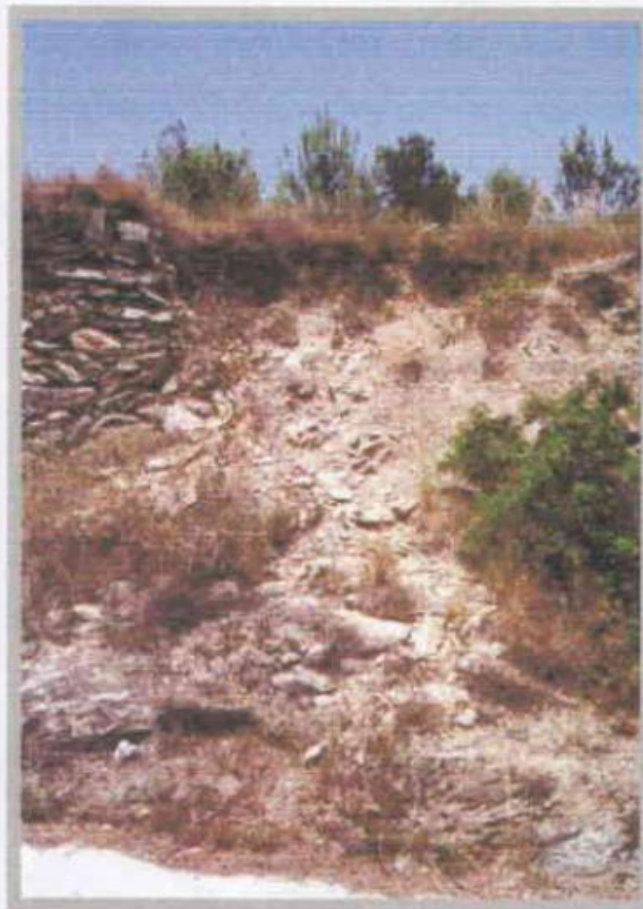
Despreniment afectant part d'un mur de pedra, al sector on s'uneix el carrer de Dalt i el Camí de Can Vila.
